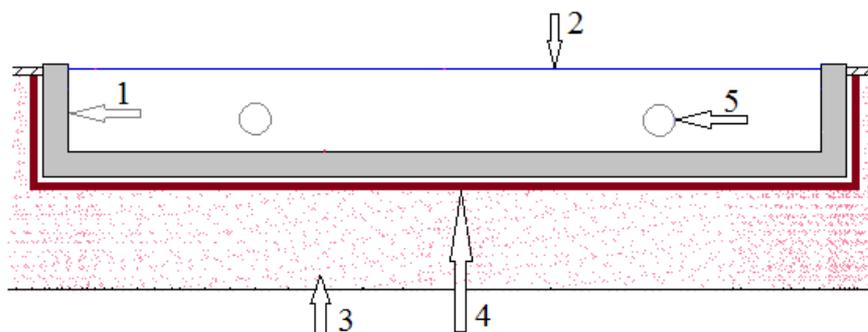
Конструктивное решение детского плавательного бассейна с железобетонной ванной (1) с уровнем воды (2), на песчаной подушке (3) с гидро- и теплоизоляцией (4) и отверстиями для организации освещения (5)
